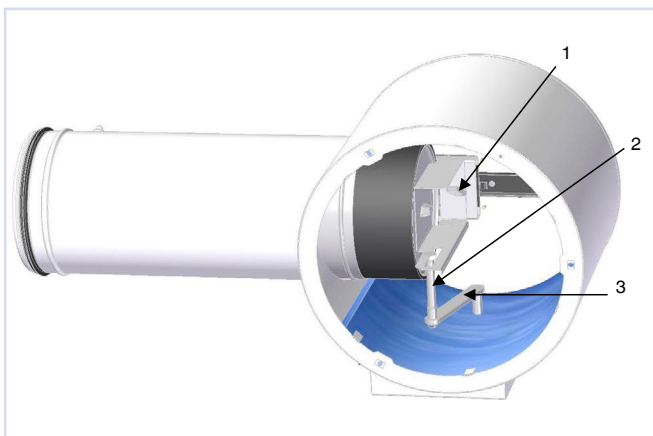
, Fjern vingeskruen (6mm) fra spjeldet (3) og dra spjeldbrakett til bakre stilling. Aktuator og spjeld er nå løse fra sarg. (MI)
